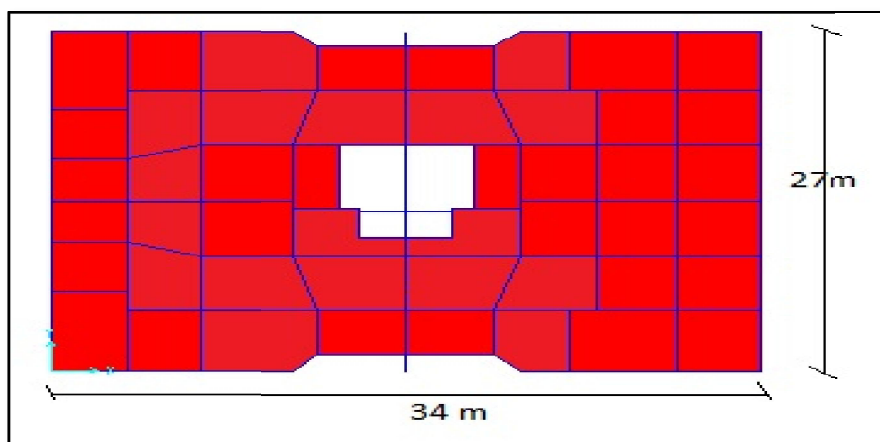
Dimensionnement d'un RDC en plan (X,Y)
